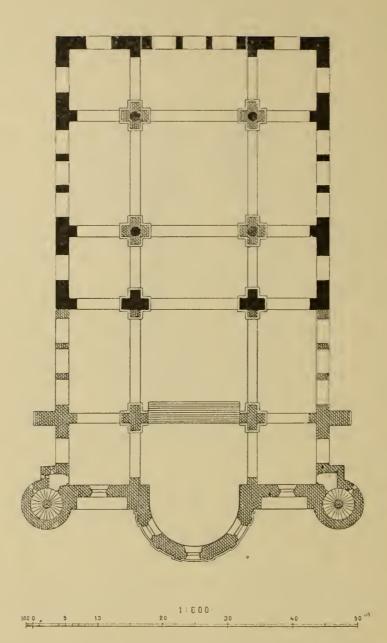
Grundriss des Domes von Trier. (Ræmischer Bau mit dem von Erzbischof Poppo begonnenen Erweiterungsbau.)
